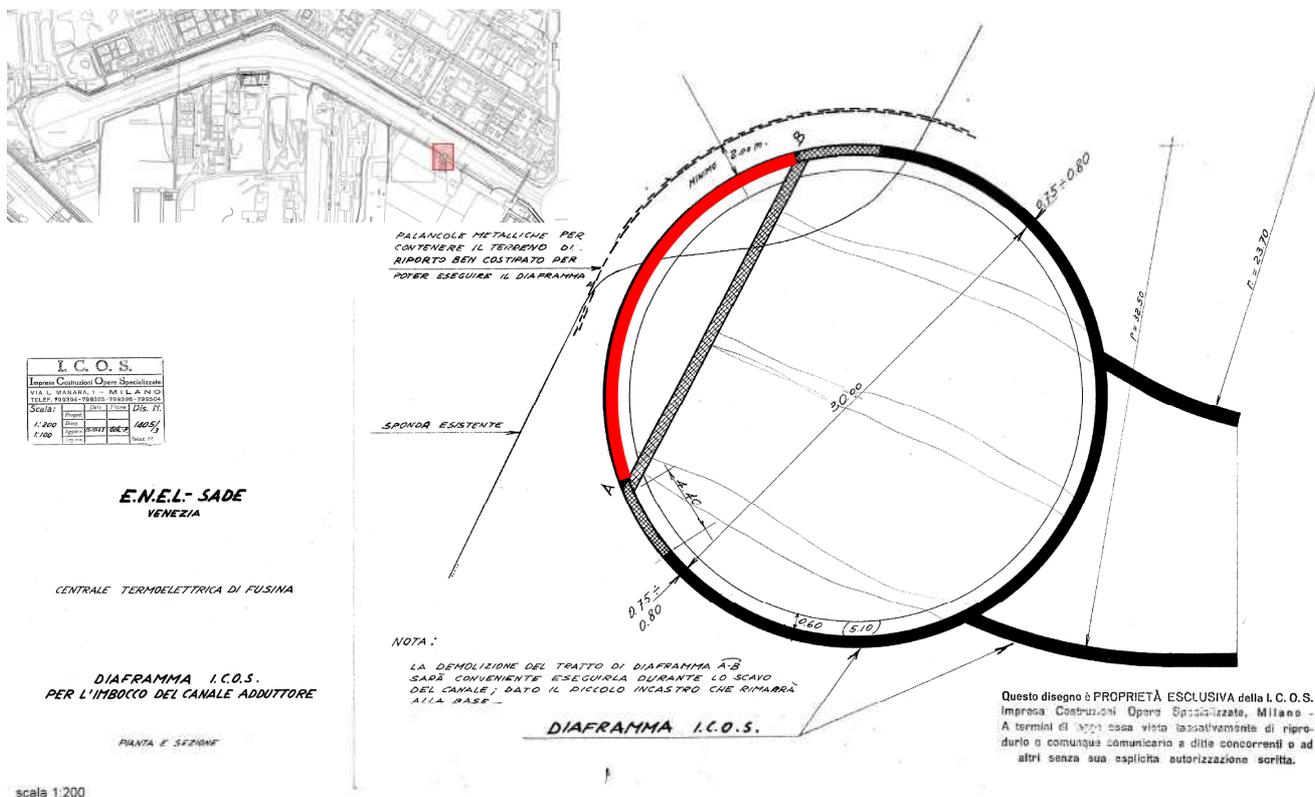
planimetria diaframma ICOS realizzato per la realizzazione dell'imbocco del canale adduttore dell'opera di presa
